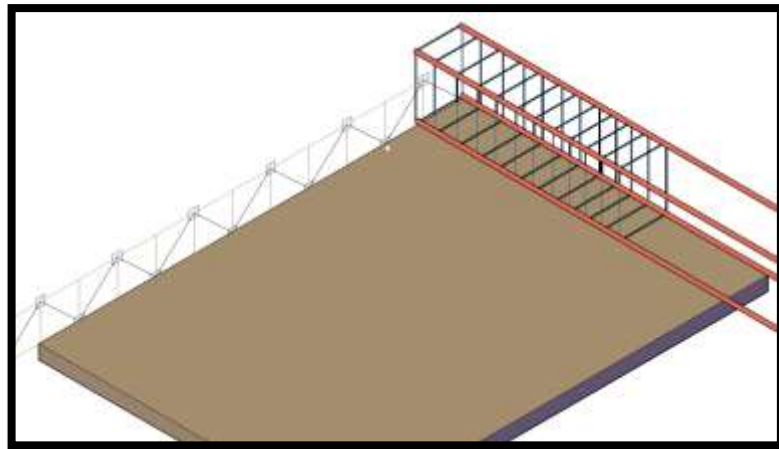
Detalle Constructivo de Apoyo de losa sobre viga perimetral
